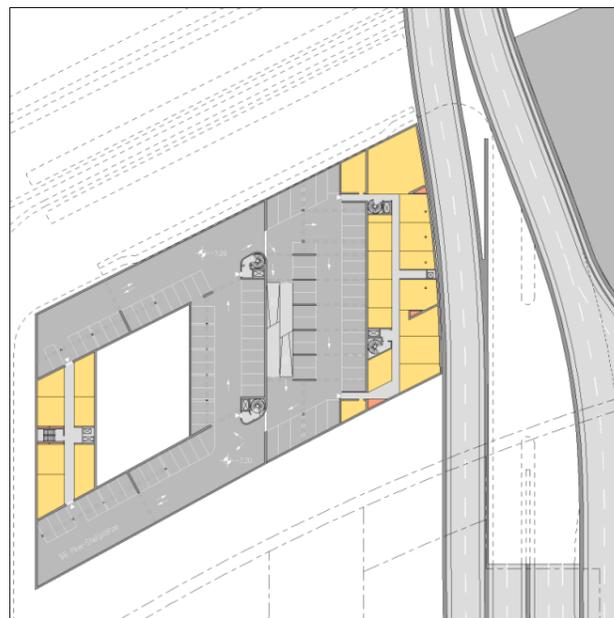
TG Variante 1 | 2. Untergeschoß
